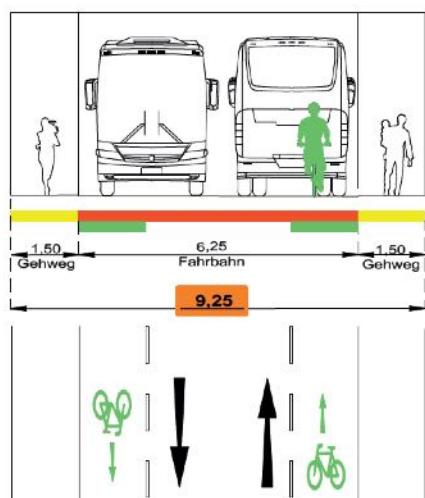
Übersichtsplan Planfall 4, [Quelle: PLANUM]
